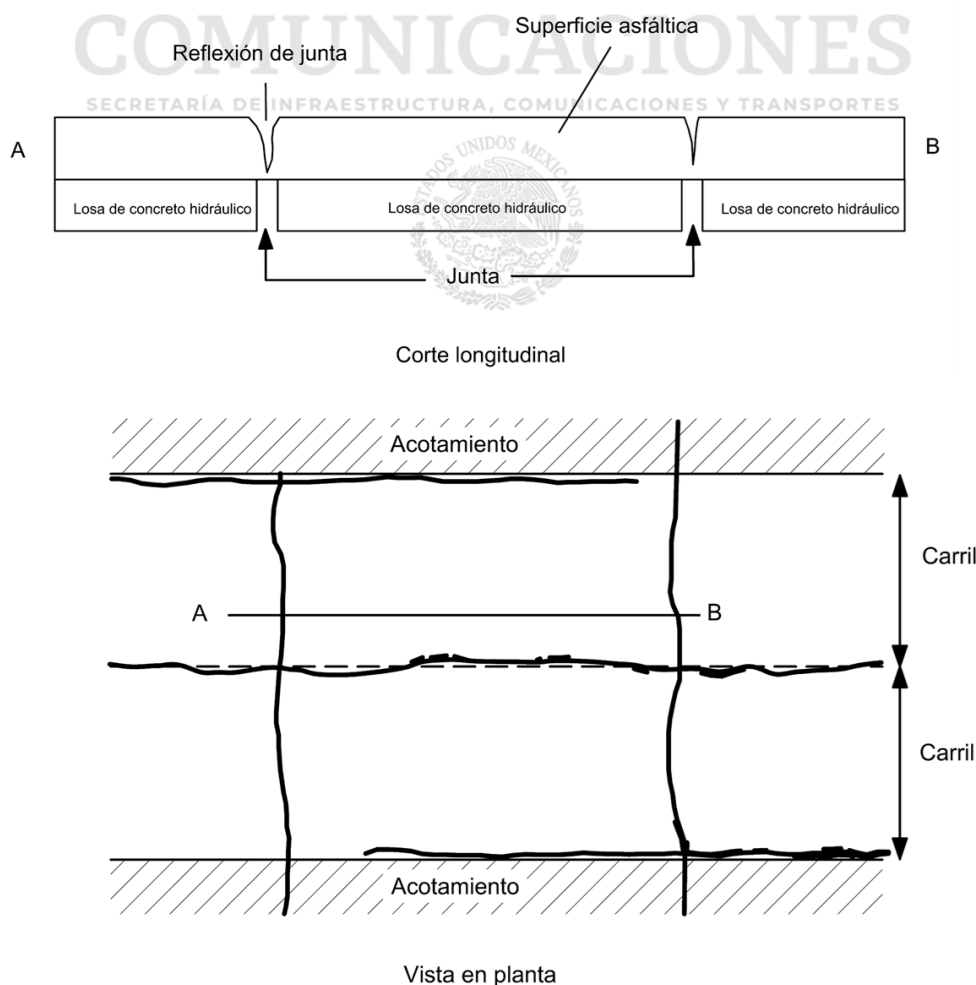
Esquema del deterioro “grieta de reflexión de junta de losas de concreto hidráulico”
